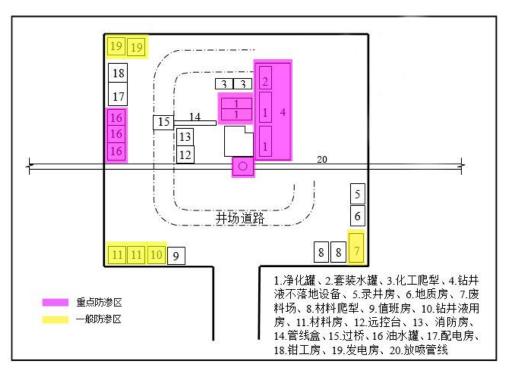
本项目钻井井场平面布置示意图(单井)
